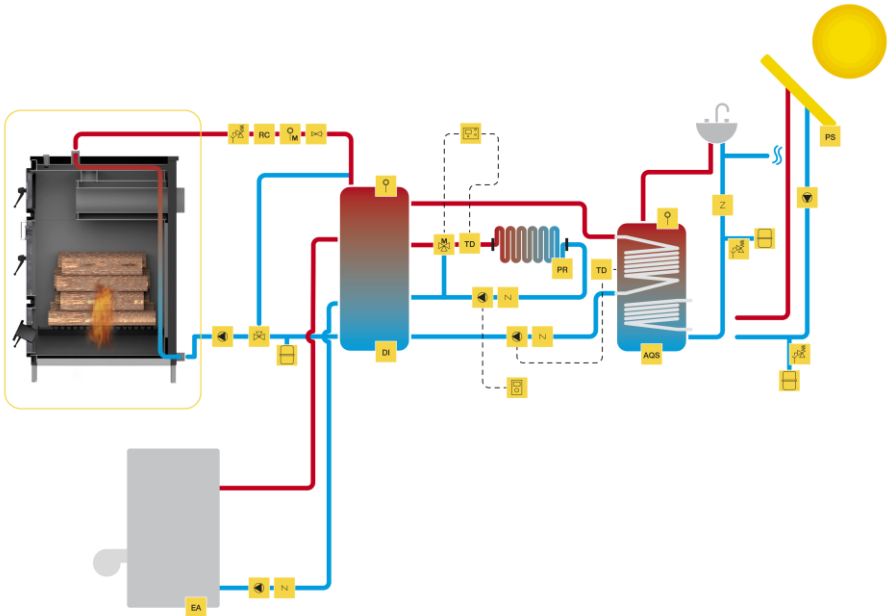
Esquema de instalação para aquecimento central e aquecimento de águas domésticas com acumulador
